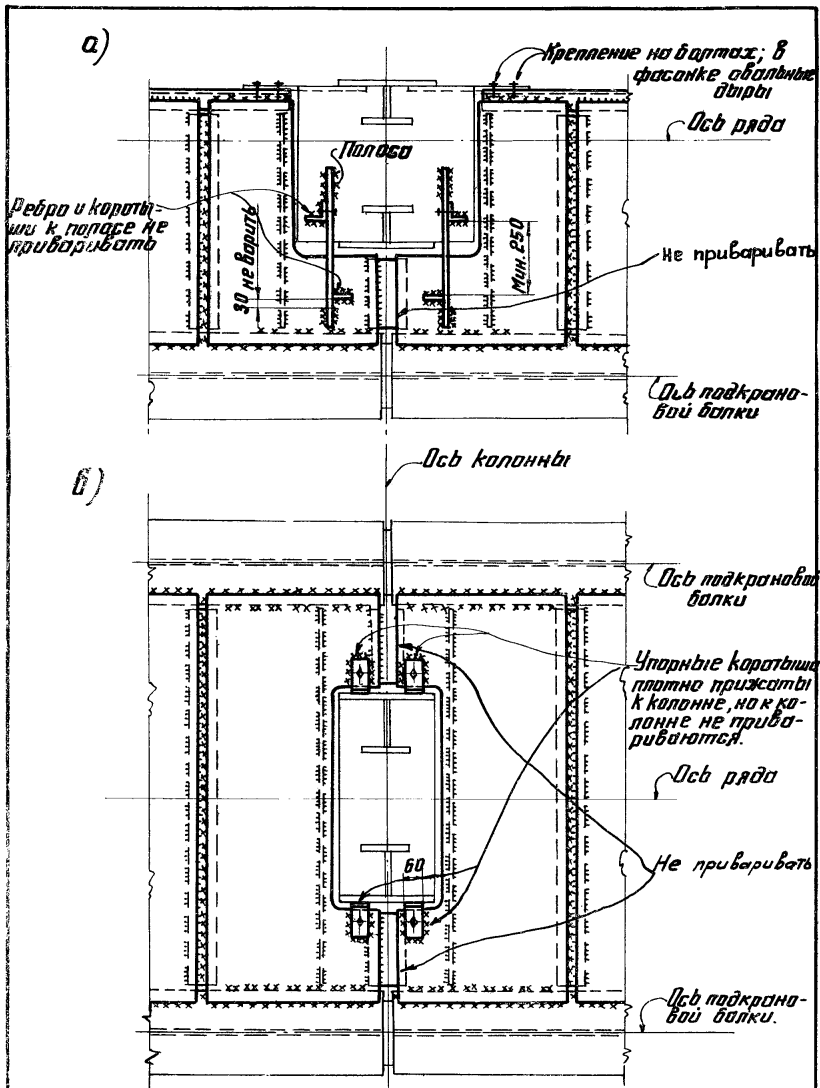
Крепление верхнего пояса разрезных подкрановых балок при наличии тормозных блоков:
